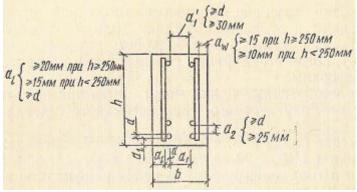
Размещение арматуры в поперечном сечении балок: aL- защитный слой бетона для рабочей арматуры; aw- то же для поперечной арматуры; d- наибольший диаметр рабочих стержней; a1- расстояние в свету между нижними (при бетонировании) продольными стержнями; a1-то же, между верхними (при бетонировании) стержнями; a2-расстояние в свету между рядами продольных стержней.
